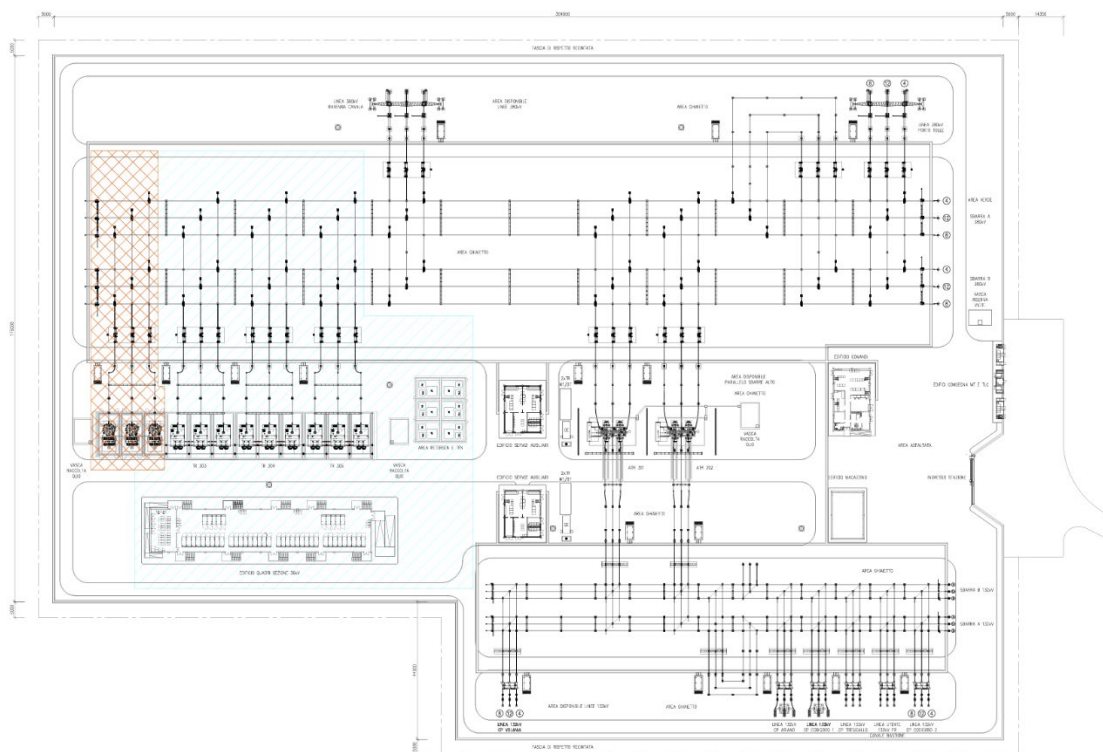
Planimetria elettromeccanica SE 380/132/36 kV "Fiscaglia"
